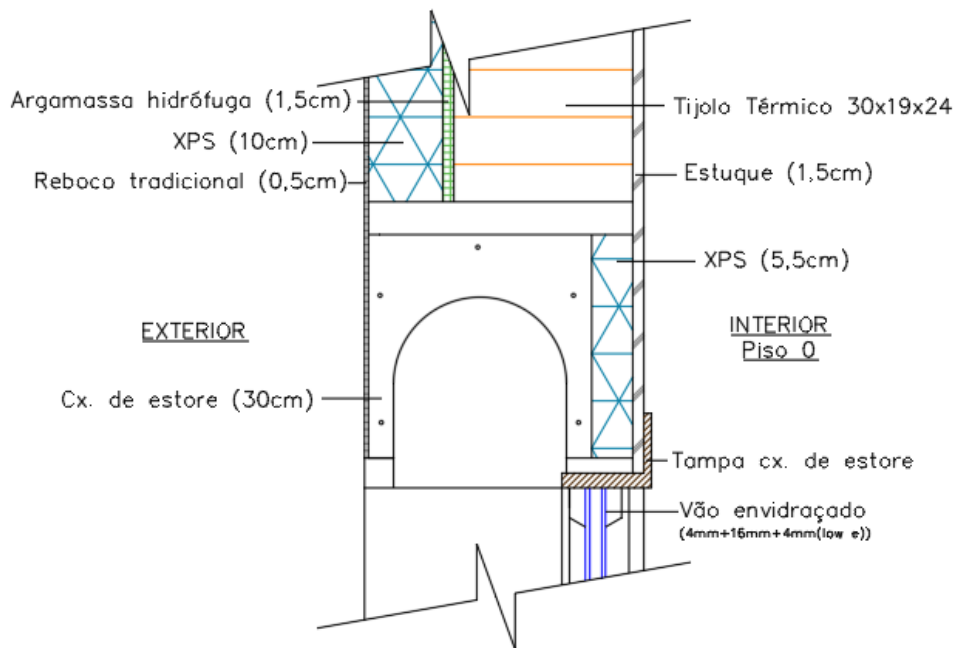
Exemplo de pormenor construtivo do vão envidraçado da proposta de alteração
